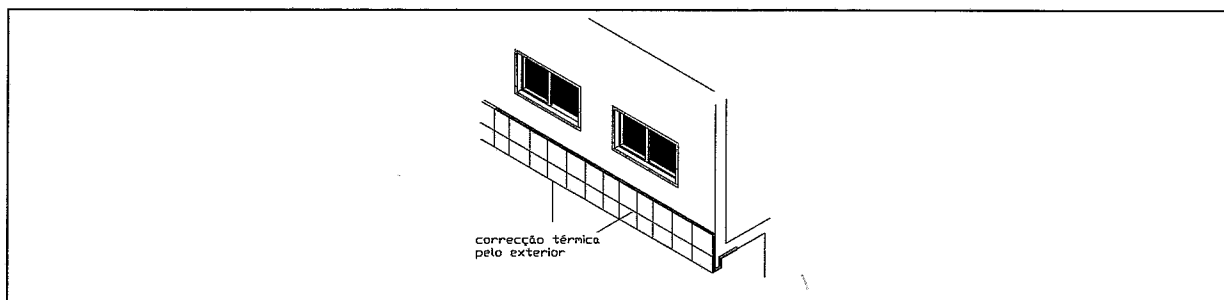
Perspectiva possível da correcção térmica pelo exterior em zona de ligação de parede com laje de pavimento
